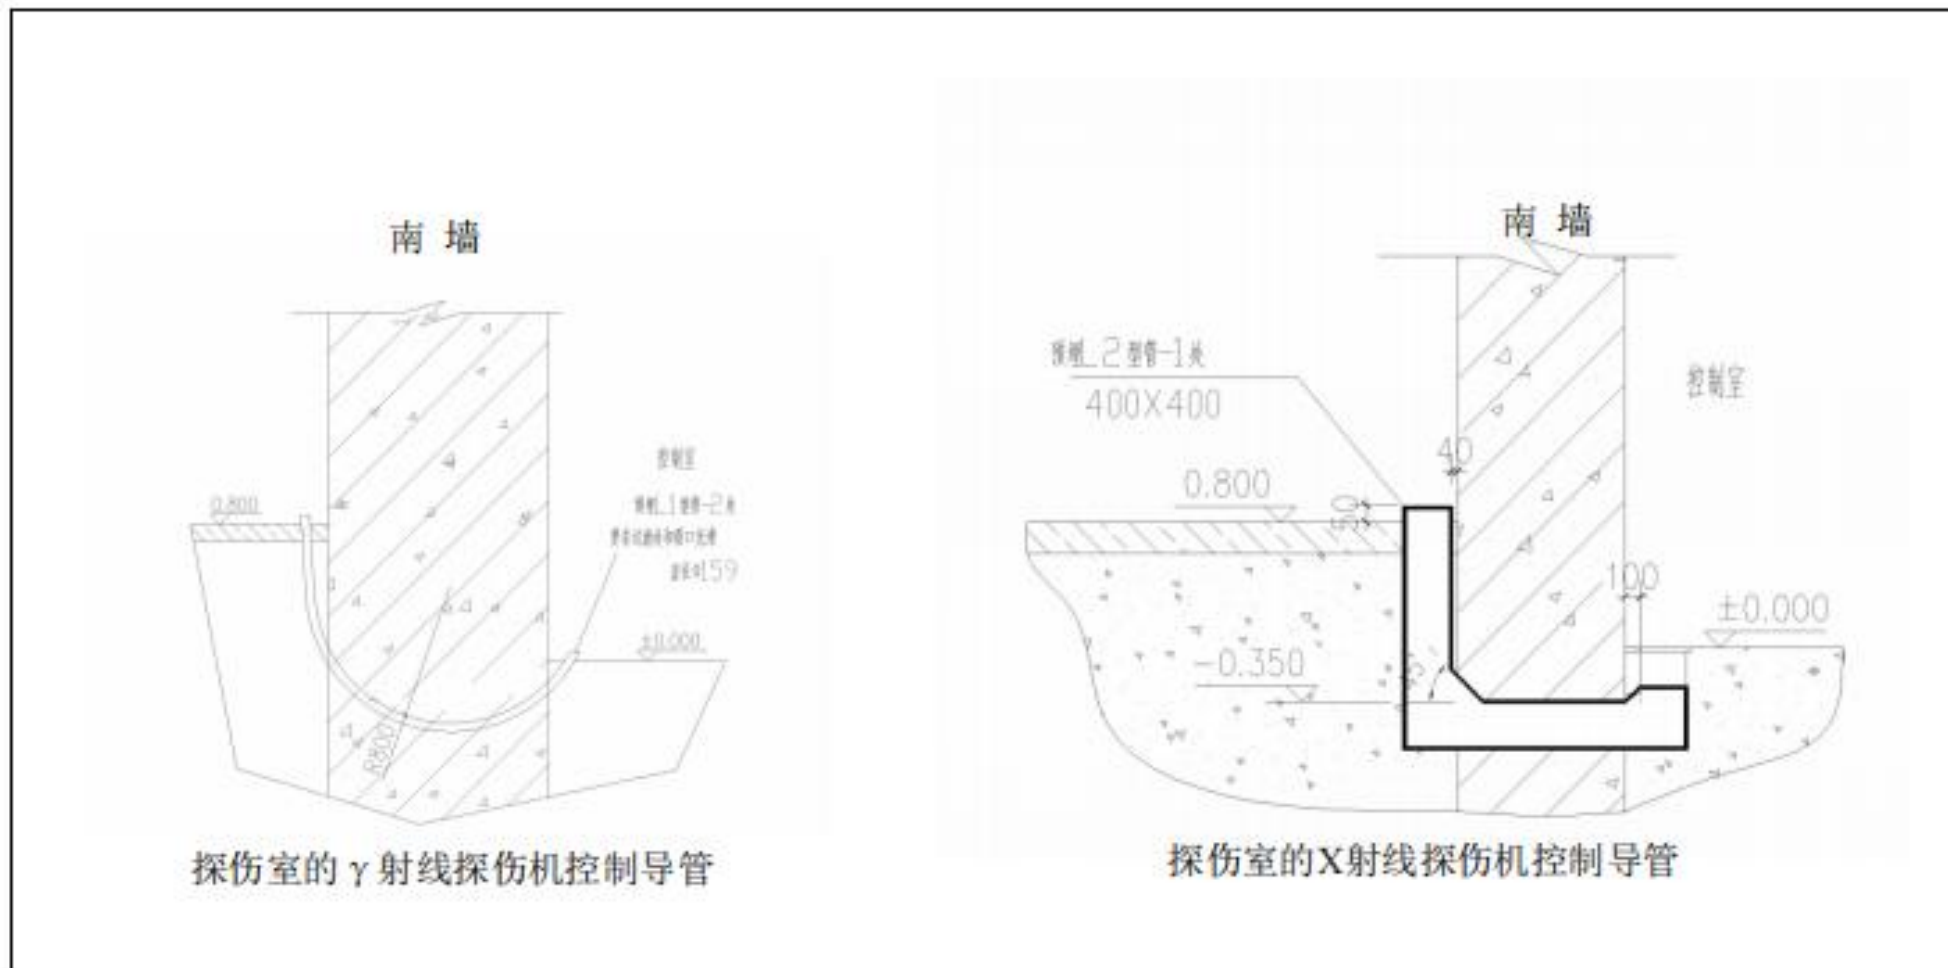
探伤室内各穿墙控制线缆剖面图（单位：mm）
